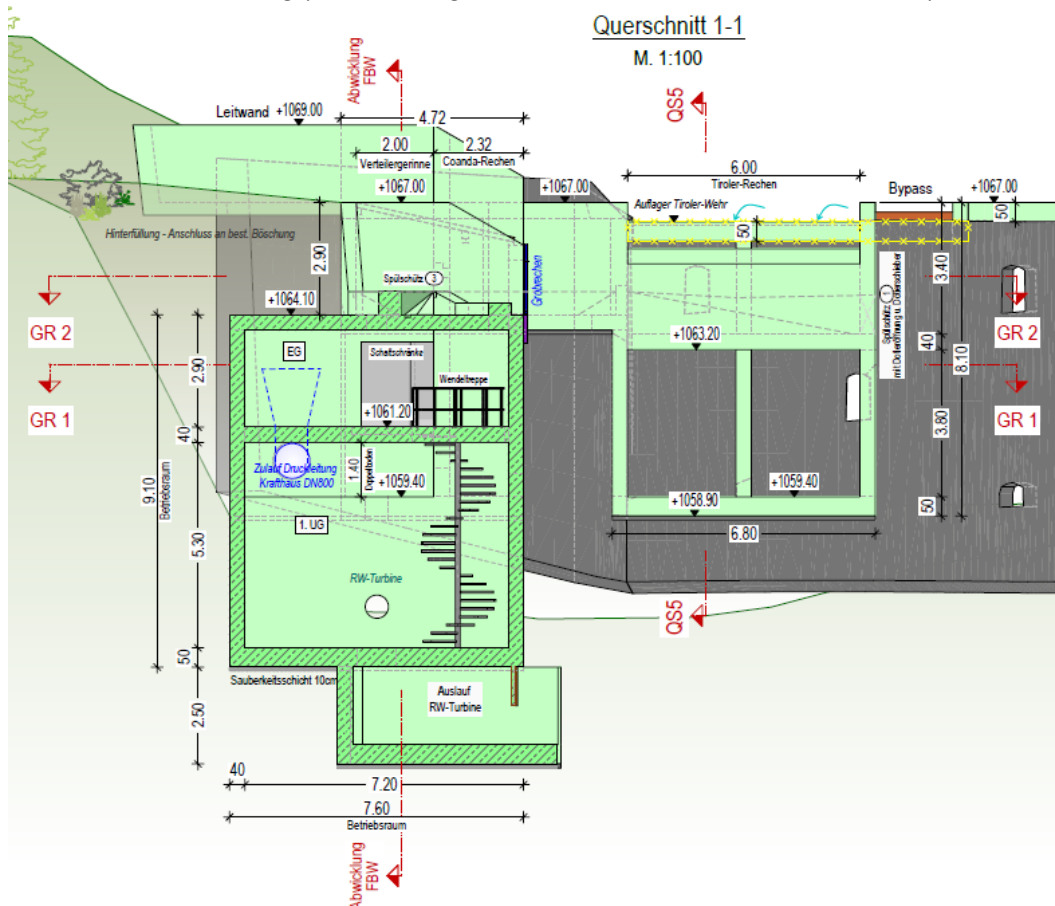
Querschnitt geplantes Fassungsbauwerk – Betriebsräume
